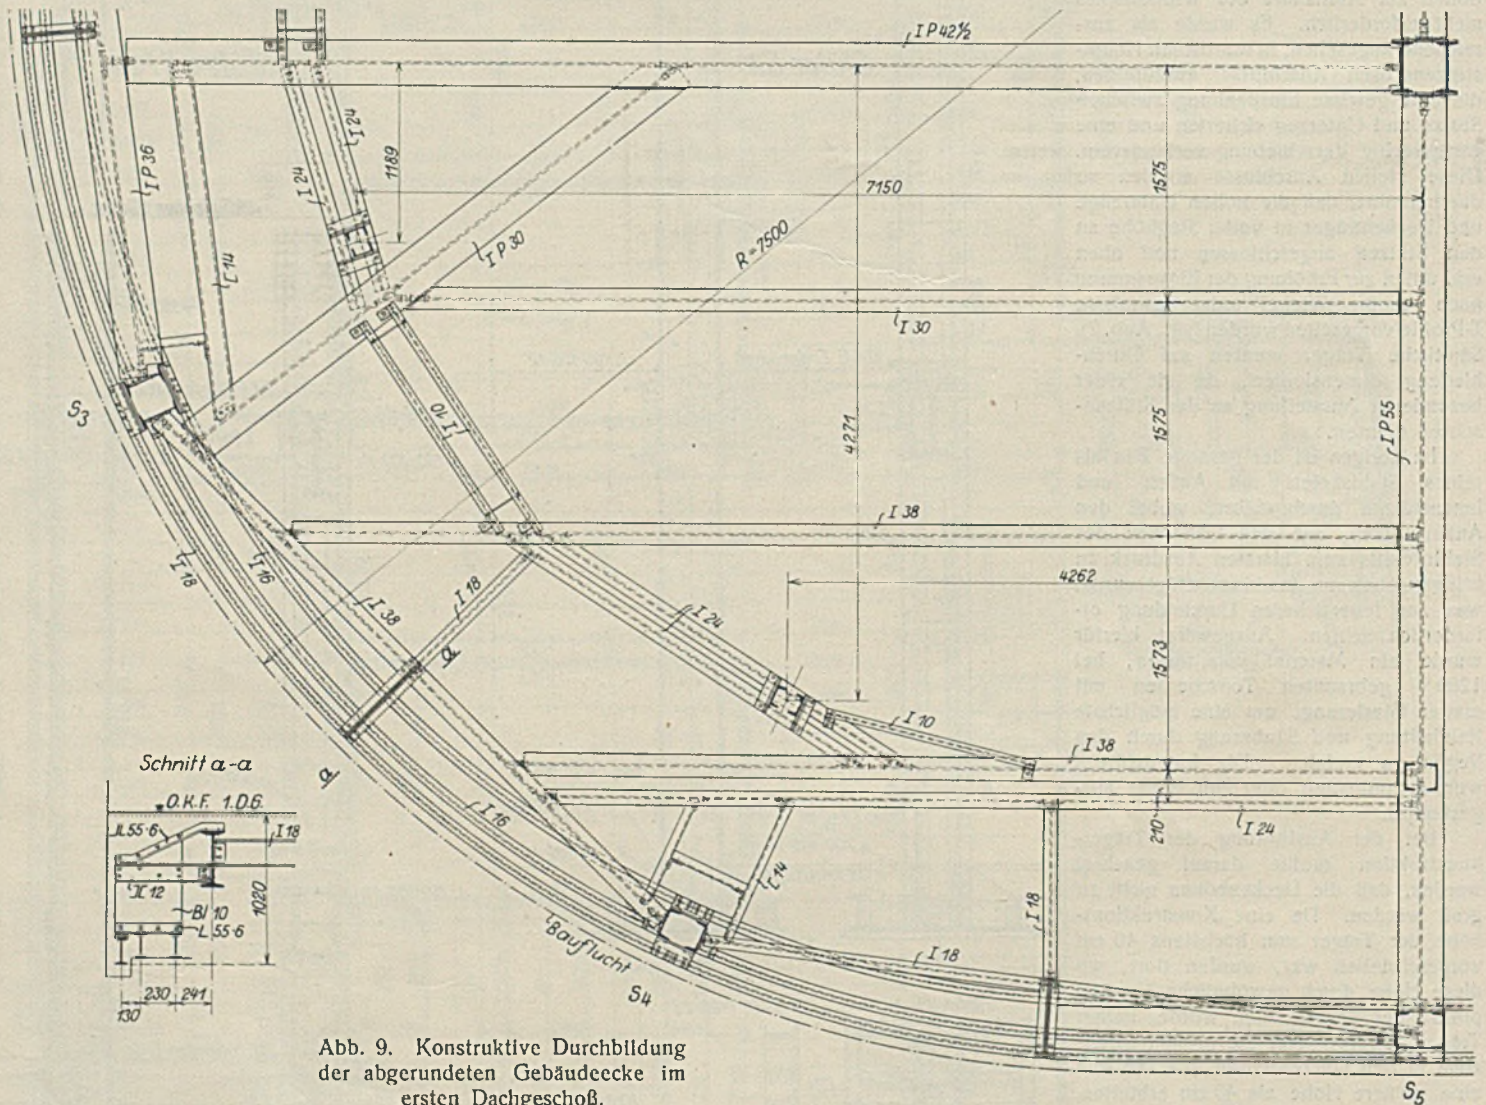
Konstruktive Durchbildung der abgerundeten Gebäudecke im ersten Dachgeschoß.
